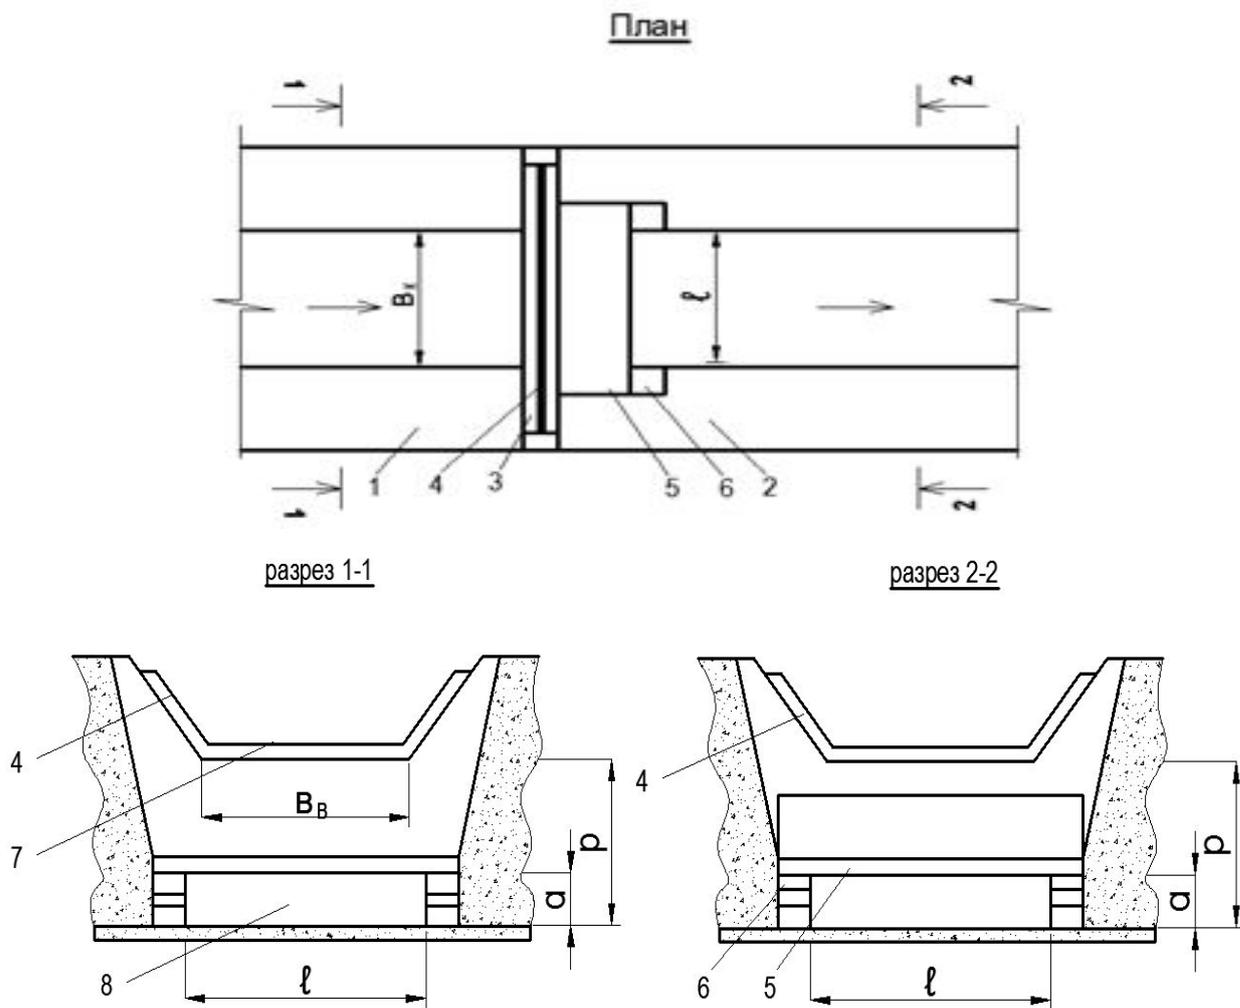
Схема комбинированного водомера типа «Водослив-насадок» применительно к водотоку трапецидального сечения (изготавливается только из бетона)
